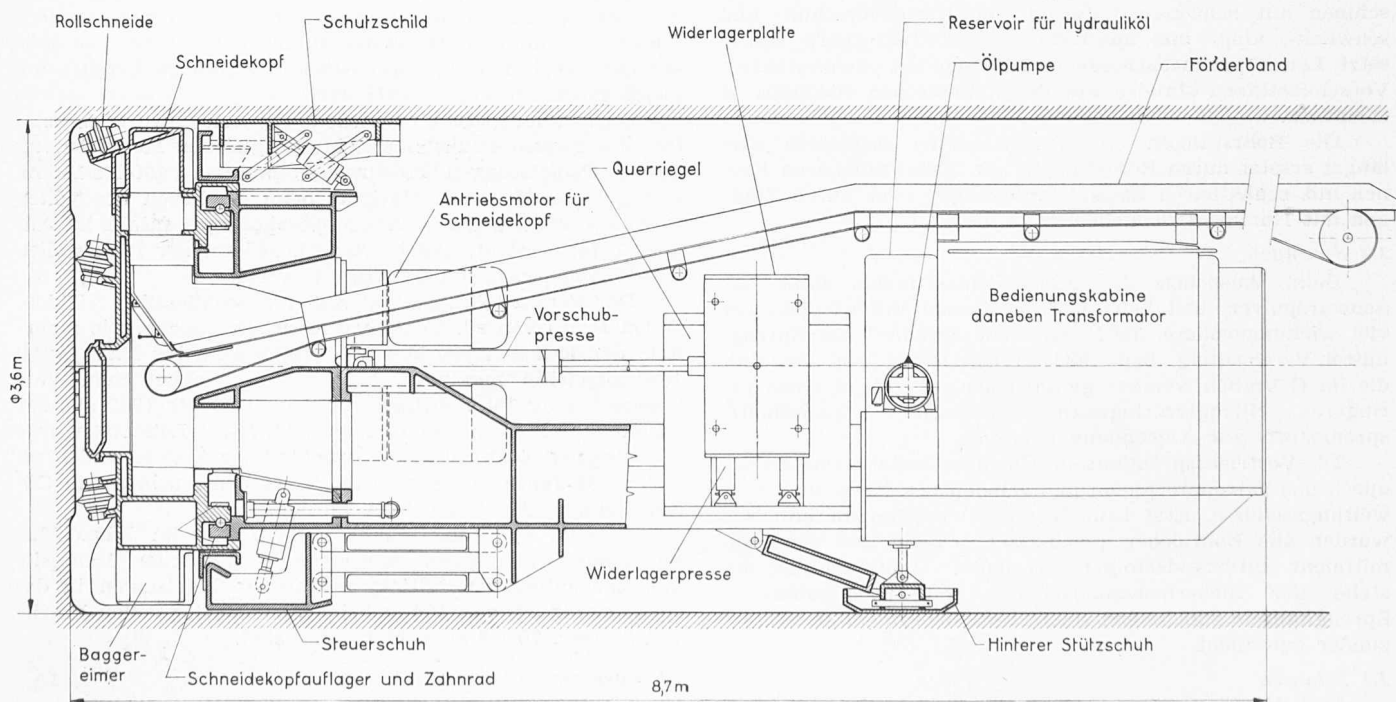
Robbins-Stollenvortriebsmaschine für einen Ausbruchdurchmesser von 3,6 m, Längsschnitt 1:55
